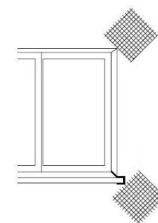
Reforço da armadura no contorno dos vãos da fachada [14]
